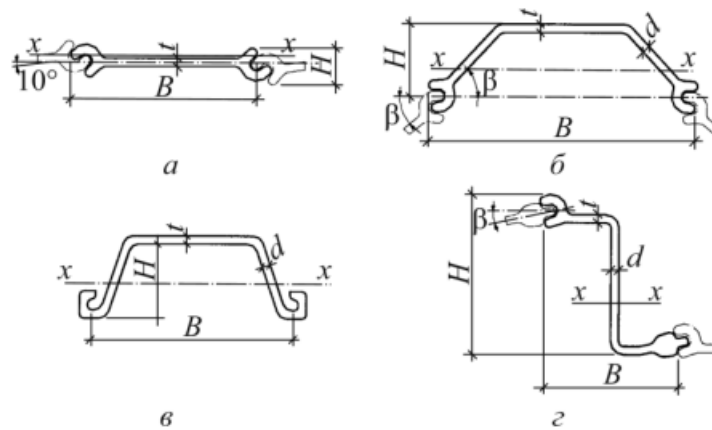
Профили металлического шпунта: а – плоский; б – корытный; в – корытный типа «Ларсен»; г – Z-образный
